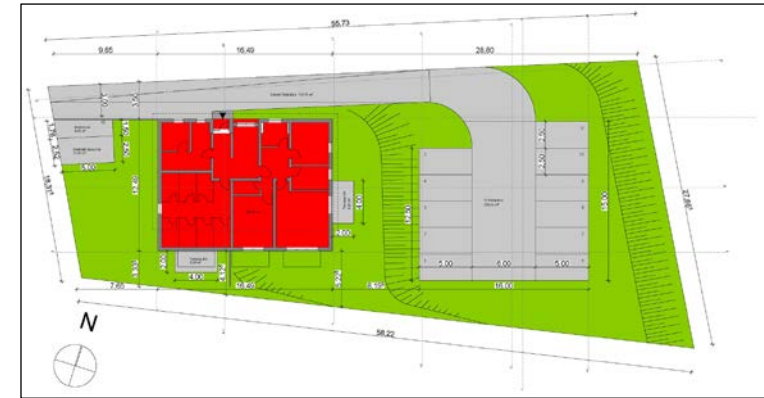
Architektenentwurf – Freiflächenplan, Stand 12/14
